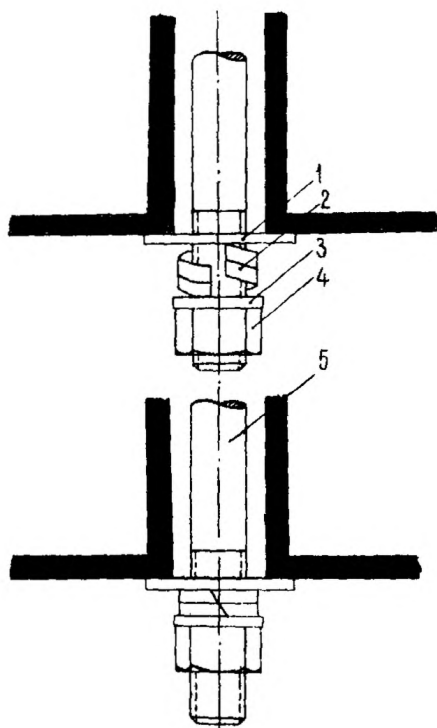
Шайба Гровера для контроля натяжения анкеров:
